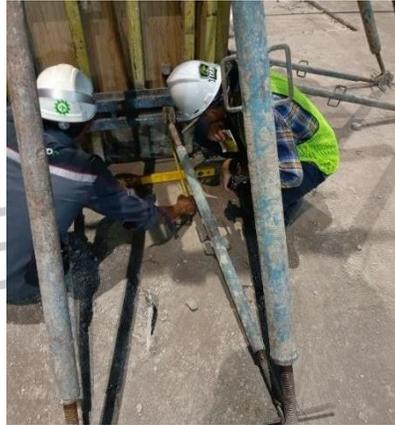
56 Pemasangan Bekisting *Shear Wall
